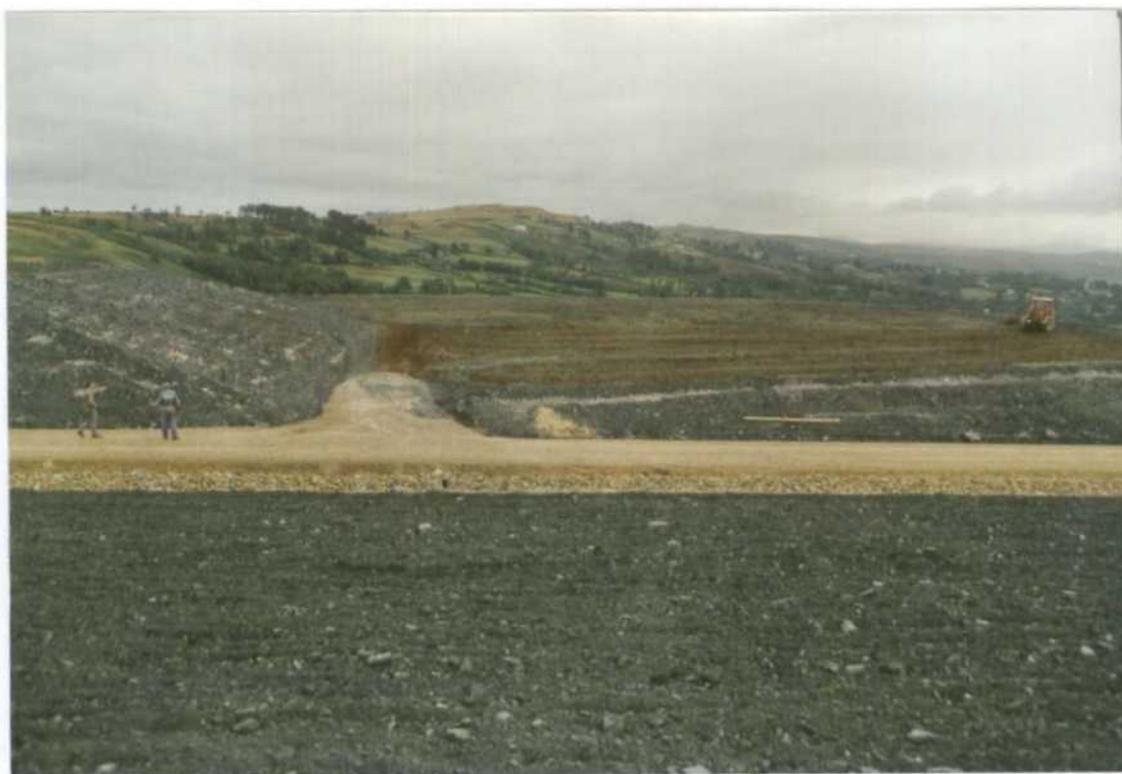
Detalle de construcción de superficie final de berma.
